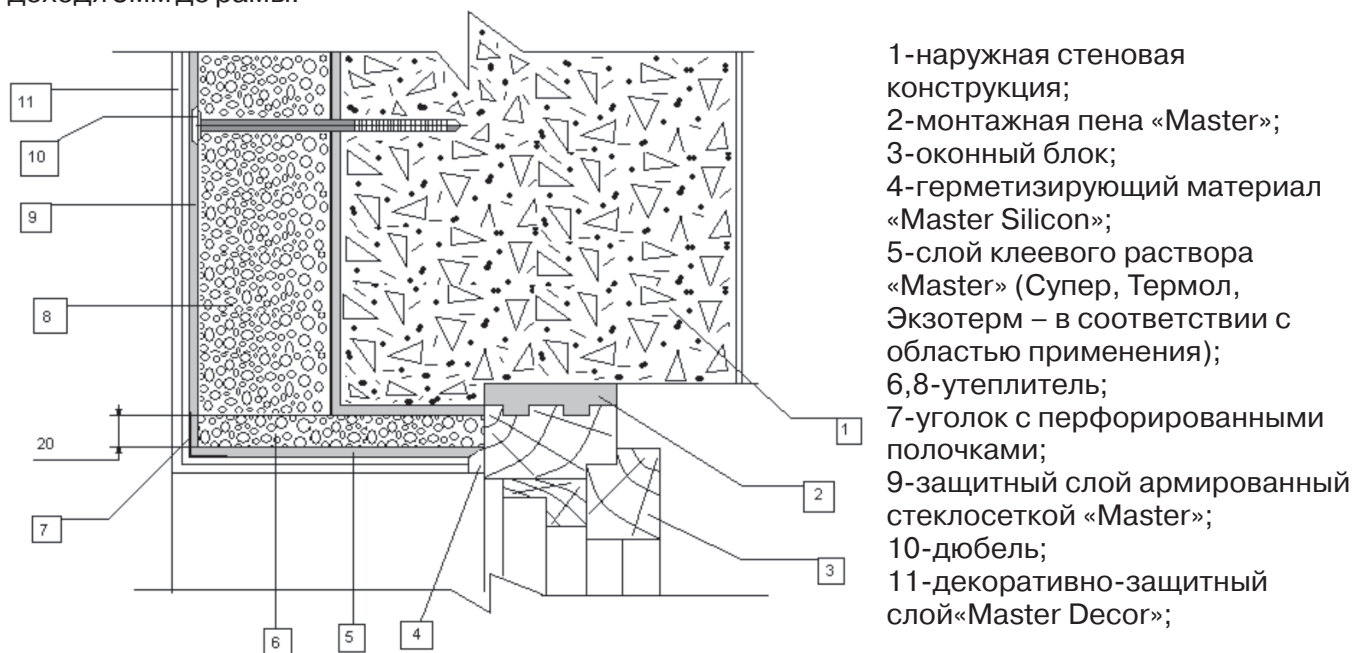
Фрагмент утепления верхнего откоса оконного проема.
